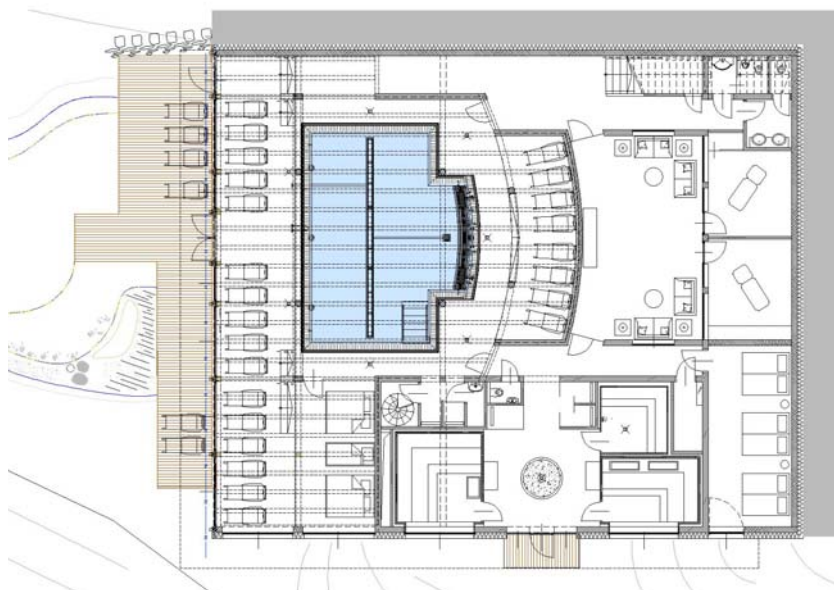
kompakter Grundriss – Zwiebschalenprinzip – Belichtungsflächen ausschließlich nach Südwesten und Südosten, NW und NO Fassade vollständig erdberührend
